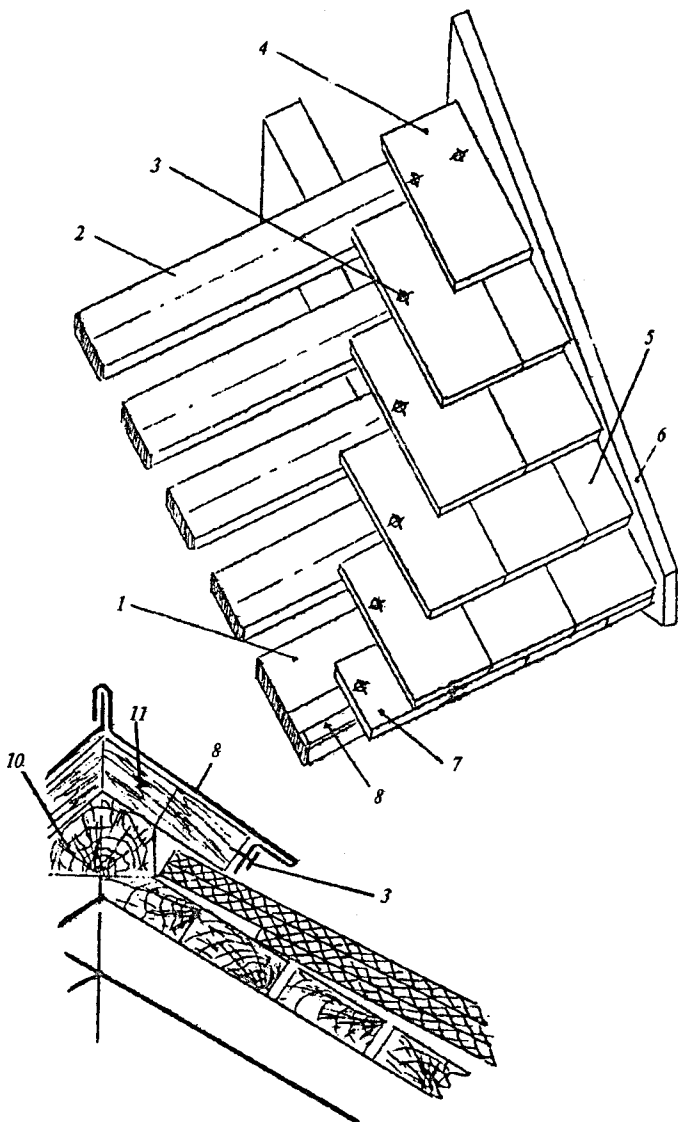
Покриття сланцевими пластинками: 1 – карнизний настил; 2 – решетування з дощок; 3 – цвях; 4 – ціла пластинка; 5 – половина пластинки; 6 – вітрова дошка; 7 – укорочена плитка; 8 – зрівнювальна планка; 9 – покриття з покрівельної сталі; 10 – коньковий брус; 11 – дошка.
